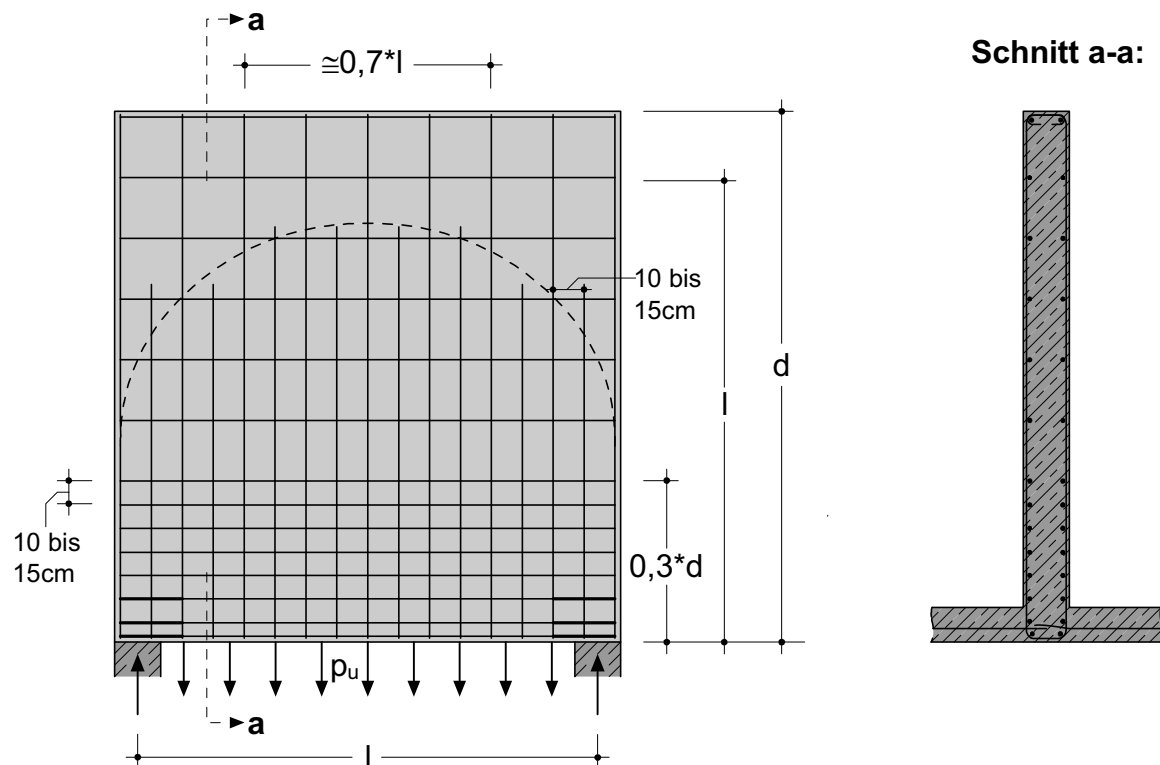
Bewehrung eines unmittelbar gelagerten Wandträgers mit angehängter Last ($l/d \leq 1$)
